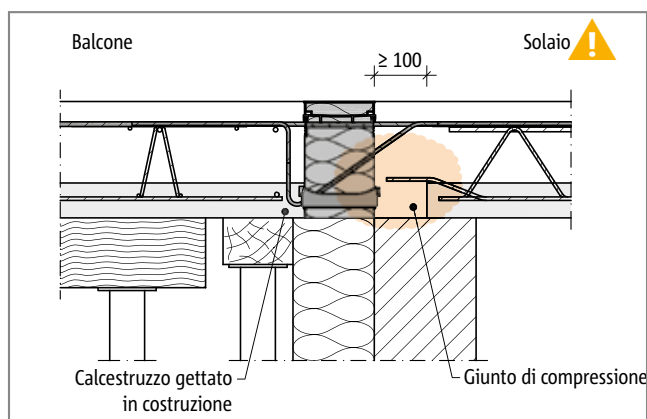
Schöck Isokorb® tipo KXT: appoggio diretto, montaggio con piastre prefabbricate (qui: $h \leq 200$ mm), giunto di compressione lato solaio
